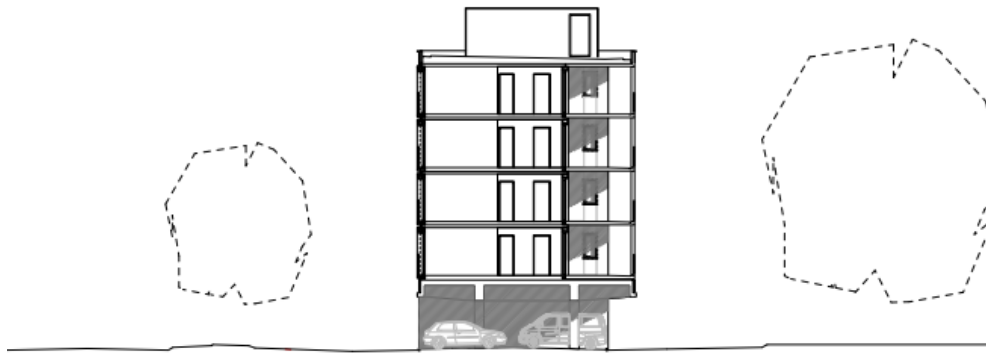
Gebäudeschnitt (©Florian Nagler Architekten)
